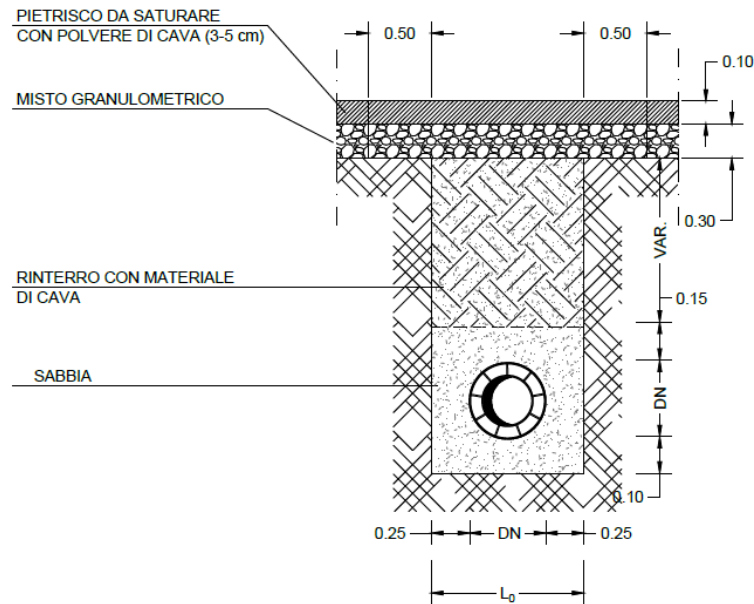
Attraversamento strada secondaria sterrata – SEZIONE B-B.
